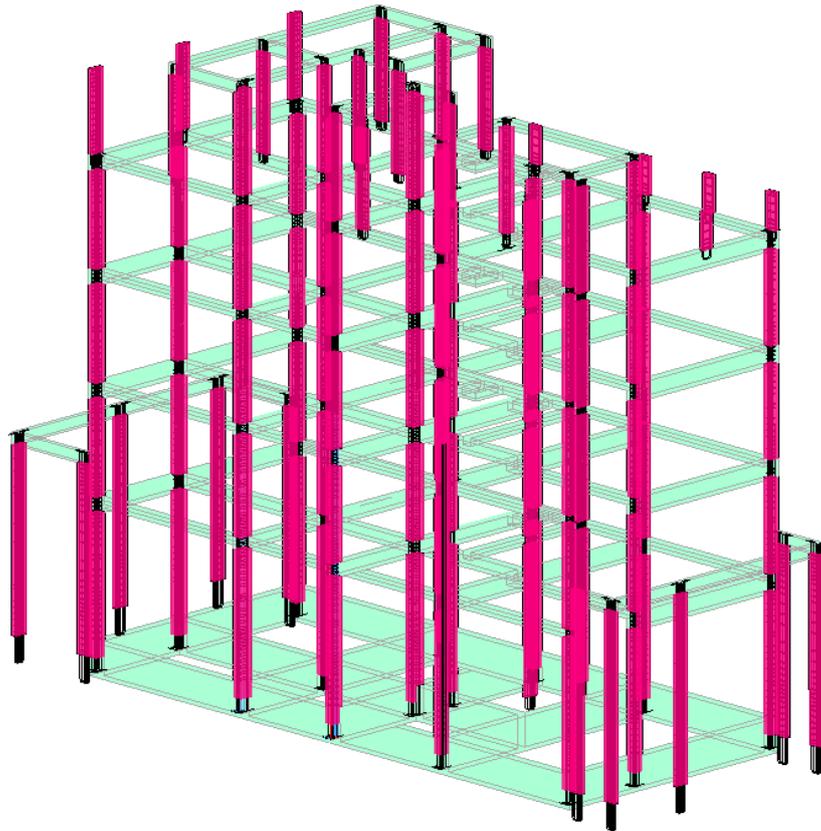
Modelo Virtual de Acero de Refuerzo de los elementos Cimentación
